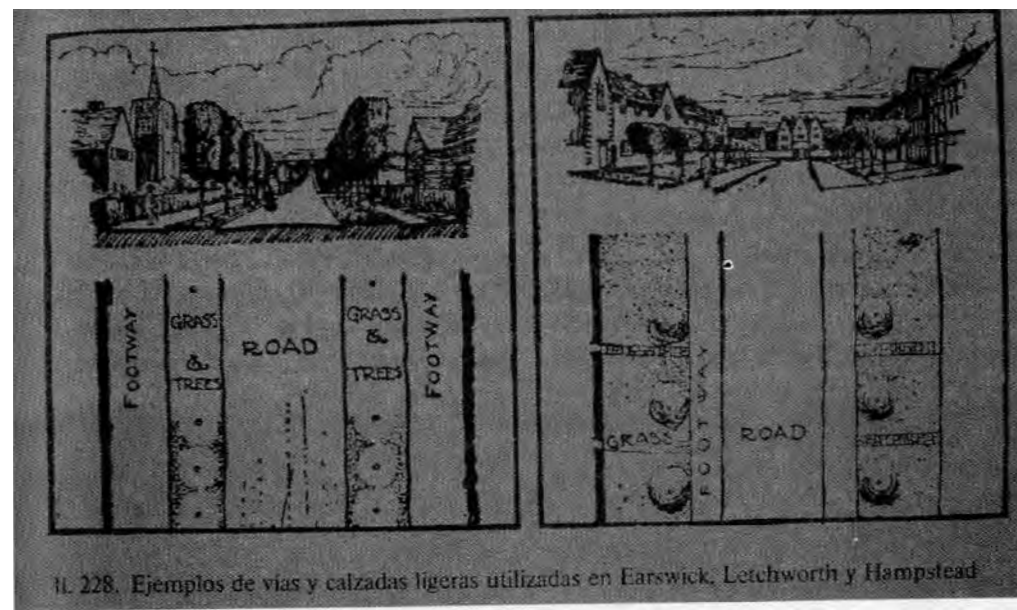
Ejemplos de vías y calzadas ligeras utilizadas en Earswick, Letchworth y Hampstead
